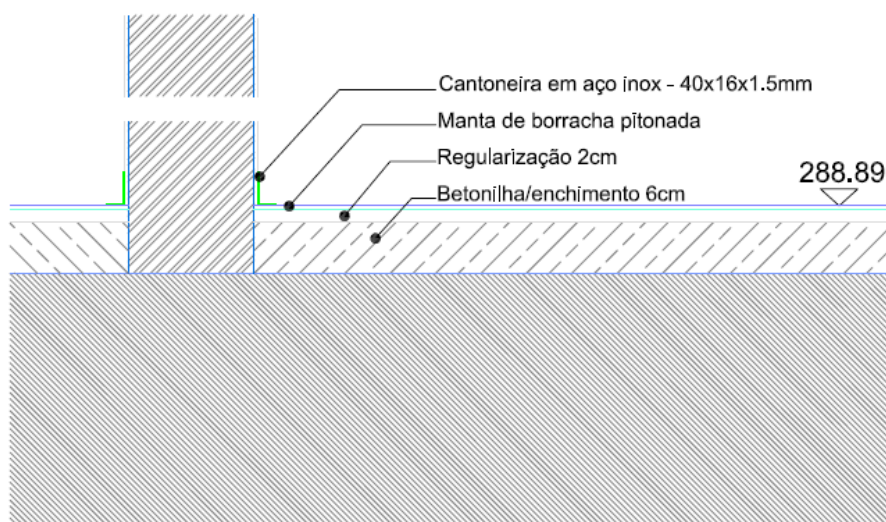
Pormenor do Pavimento com Borracha Pitonada
